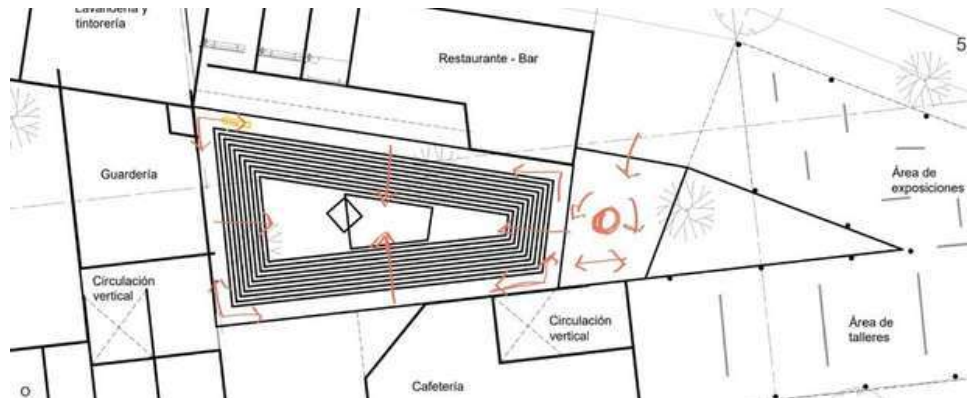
Planta arquitectónica intervenida con análisis de circulaciones. Fuente: Autoría propia
